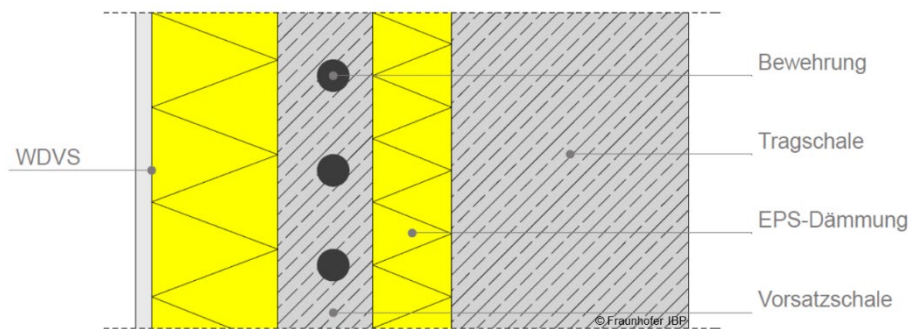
Bestandsvariante zweischalige Betonwand mit WDVS.
